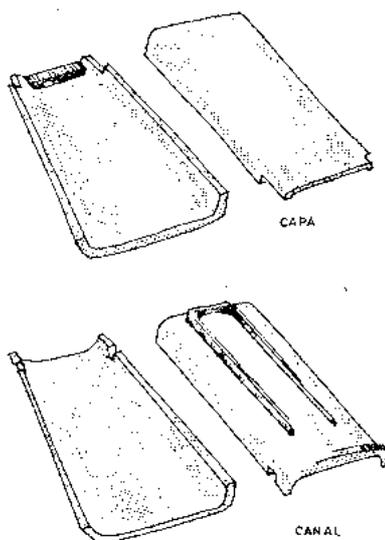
Telha cerâmica capa e canal Plan (NBR 9599, 1986)
